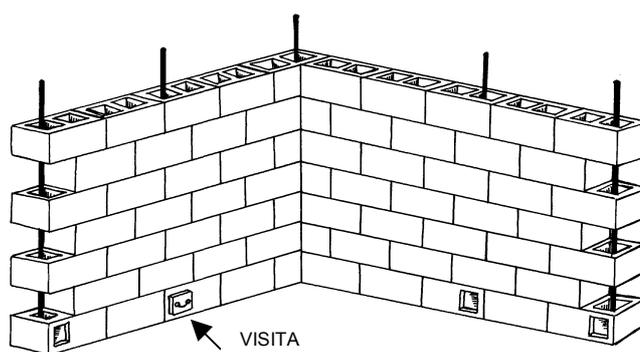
Aspecto de uma parede de alvenaria estrutural armada
